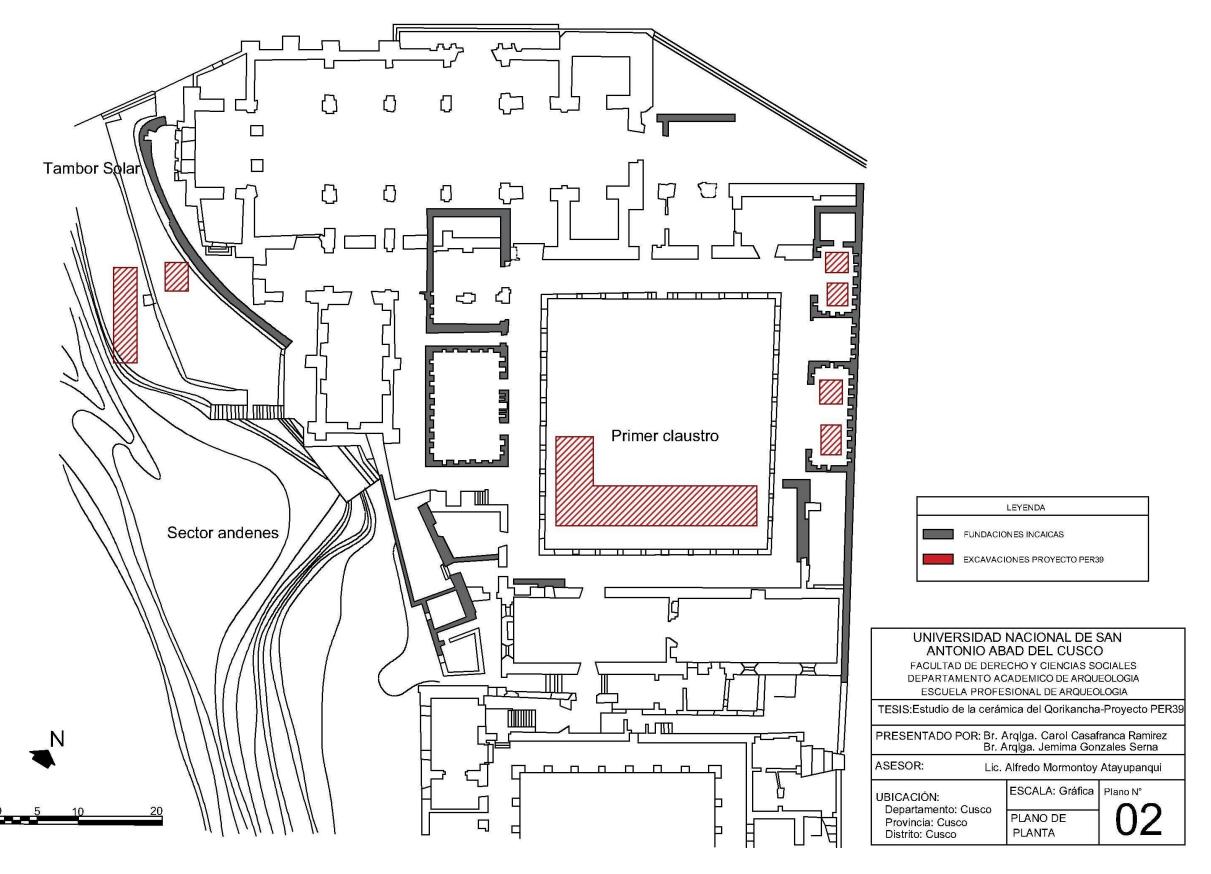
Plano de planta redibujado del Templo Qorikancha ubicando áreas excavadas durante el proyecto PER39. Fuente: (Gasparini & Margolies, 1977, pág. 232)
